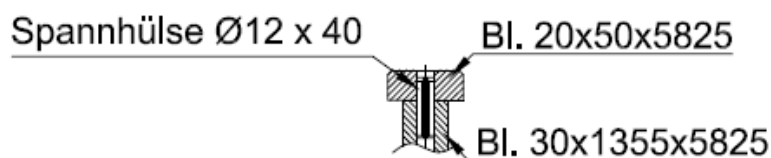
BG2; Detail Befestigung der Fahrbahn
